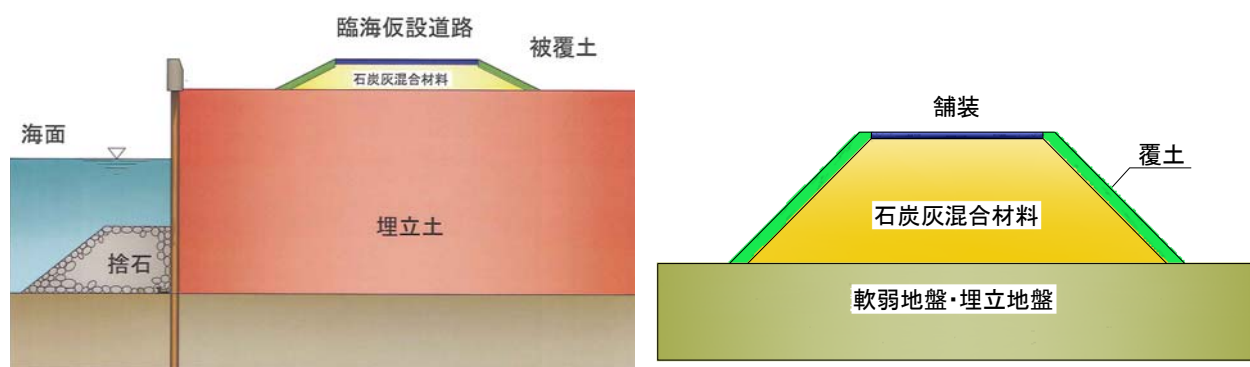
機能向上嵩上げや盛土道路イメージ断面図
